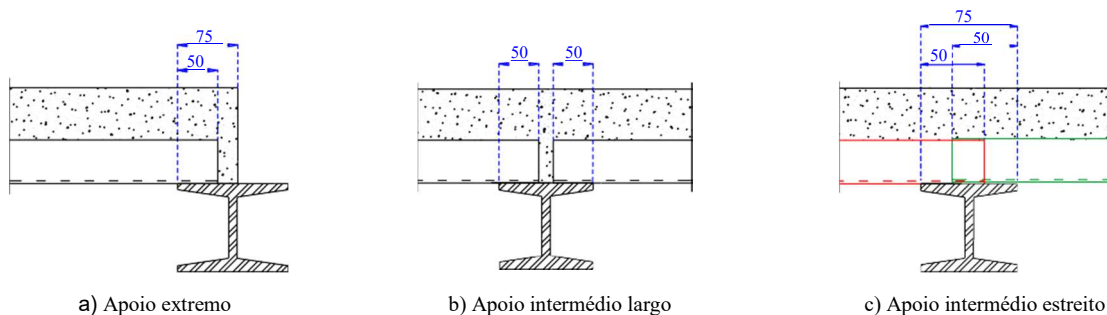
Distâncias mínimas [mm] de apoio em vigas metálicas.
